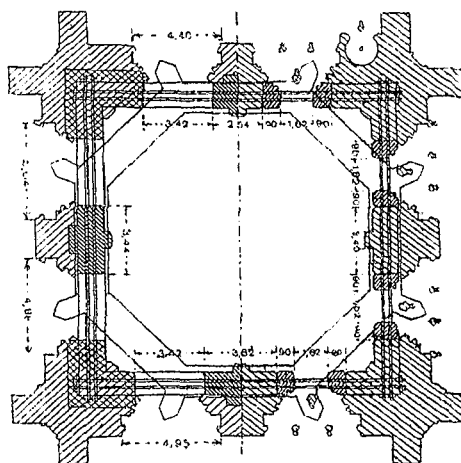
Grundriss des Geschosses unter dem Oktagon.
